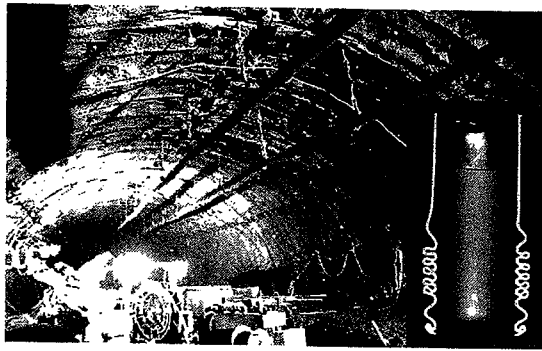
Verwendung von Stauchelementen in der Spritzbetonschale zur Erhöhung der Nachgiebigkeit, Aufweitung Semmering Basistunnel Pilotstollen; rechts Schnitt durch ein Stauchelement.
